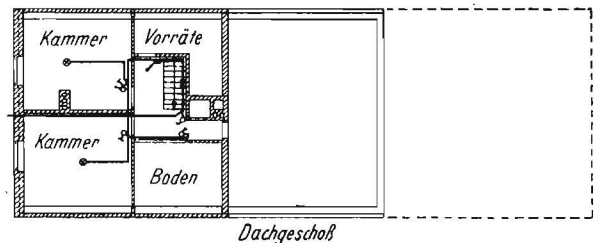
Muster-Installationsplan einer Bauernwirtschaft
